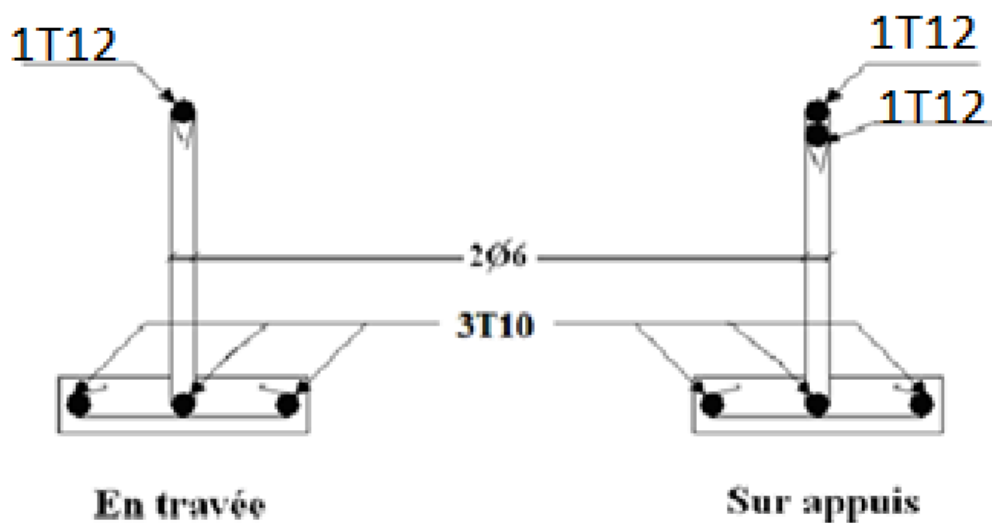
Ferrailage des poutrelles en Travée et en Appuis.
